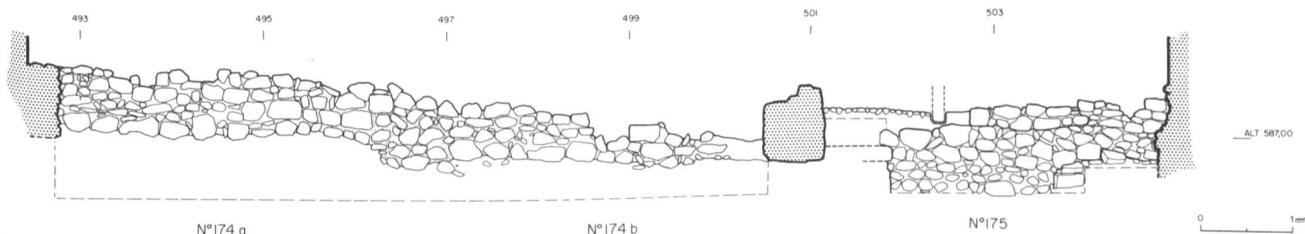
Grand-Rue 55. Elévation des fondations de la façade nord des bâtiments médiévaux.
